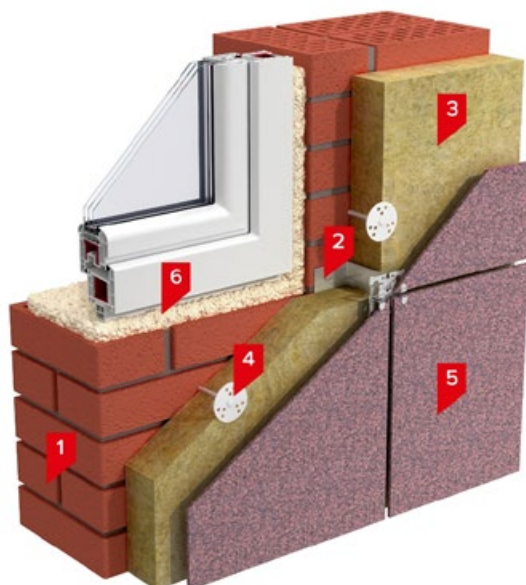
Система фасадная теплоизоляционная композиционная [ТН-ФАСАД Вент](#). Общий вид.
